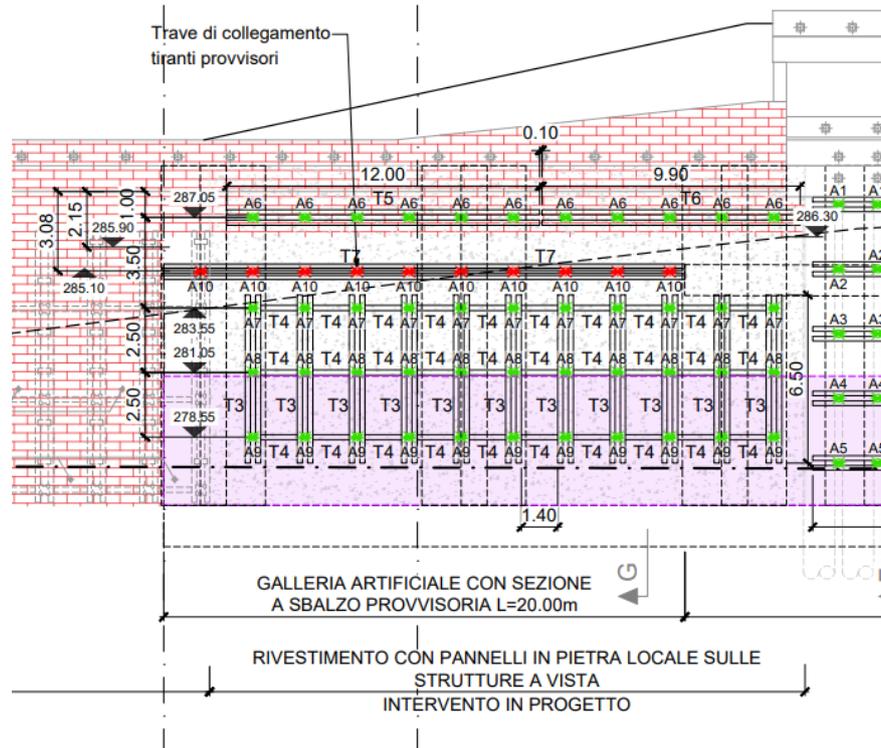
Stralcio del prospetto degli interventi sul muro da consolidare.
